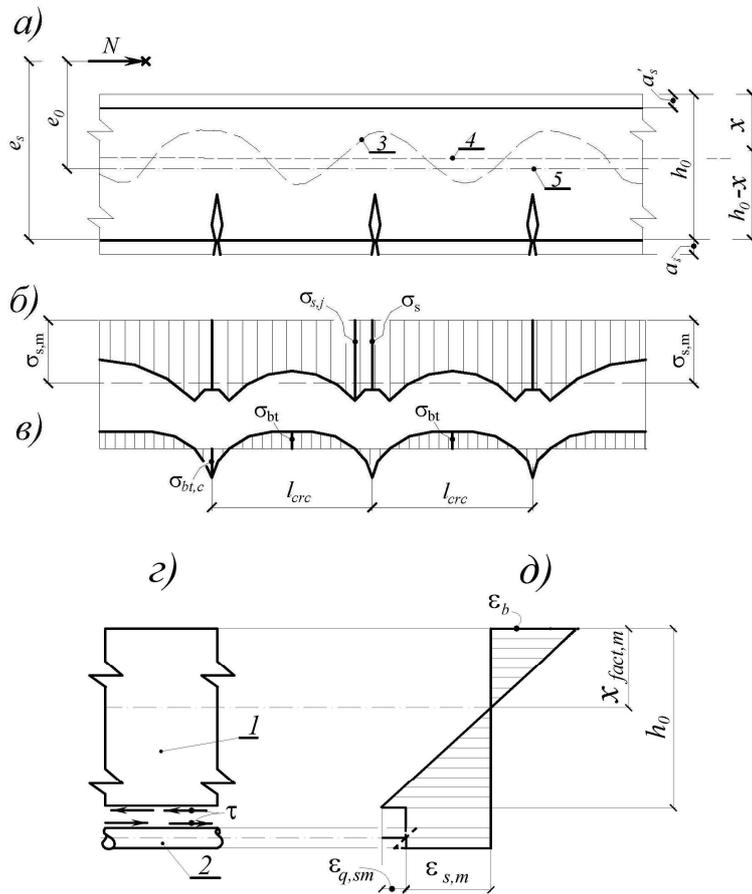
Картина трещин в средней зоне внецентрично сжатой железобетонной конструкции (а), эпюры деформаций арматуры (б) и бетона (в) на уровне оси растянутой арматуры, фрагмент железобетонной конструкции как составного стержня (г) и эпюра средних деформаций бетона и арматуры (д) в поперечном сечении составного стержня при учете средних условных сосредоточенных взаимных смещений бетона и арматуры
